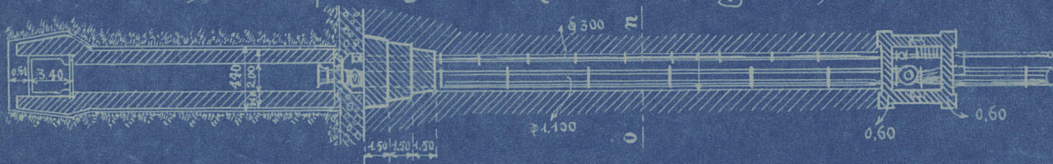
Coupe du barrage d'Arrow-Boock (Idaho E.U.)
